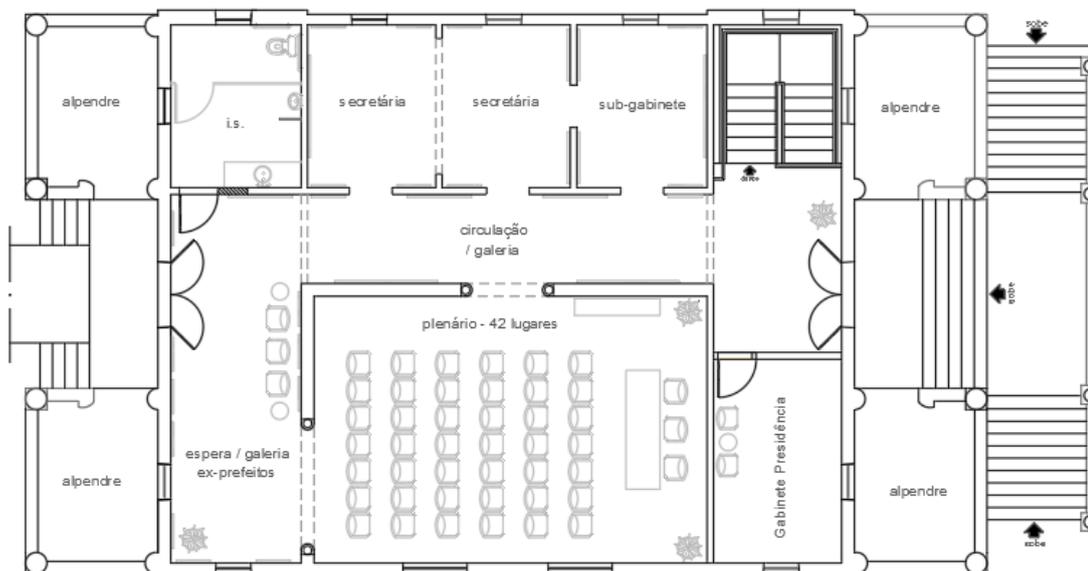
Layout Planta Baixa - Pavimento Inferior
